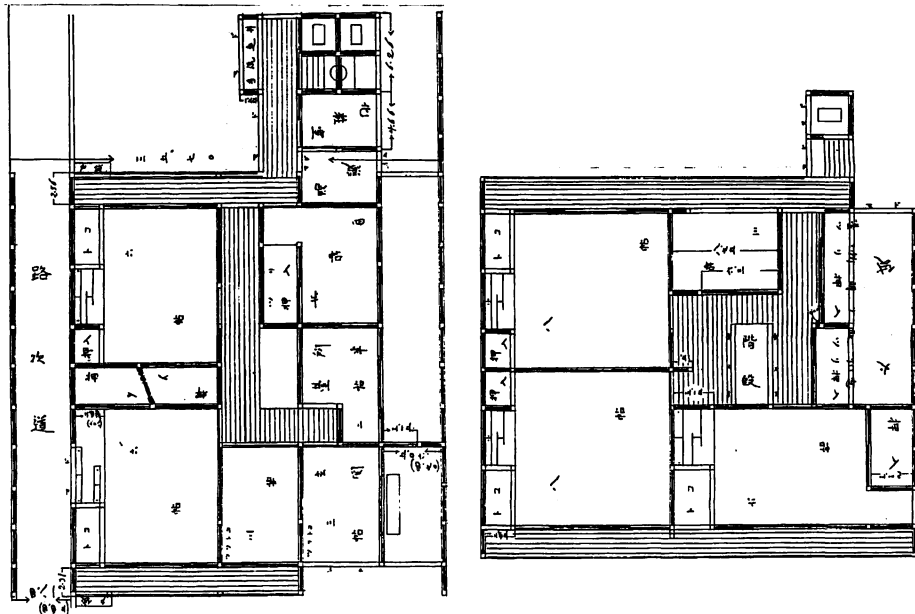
開発当初の家屋の平面図 (11 番) (上村家蔵)
